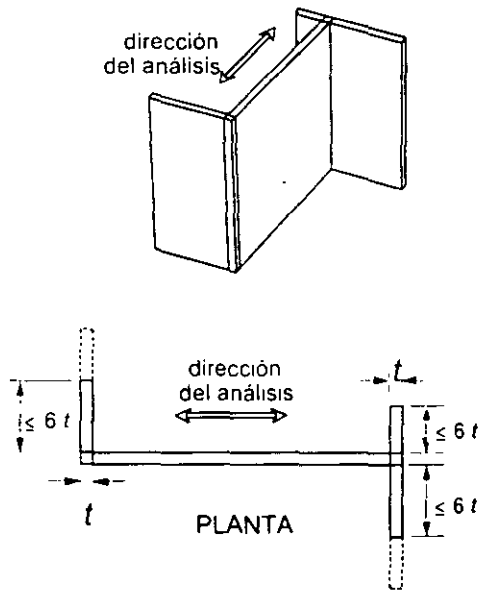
Ancho del patín a compresión en muros I, T, C o L
